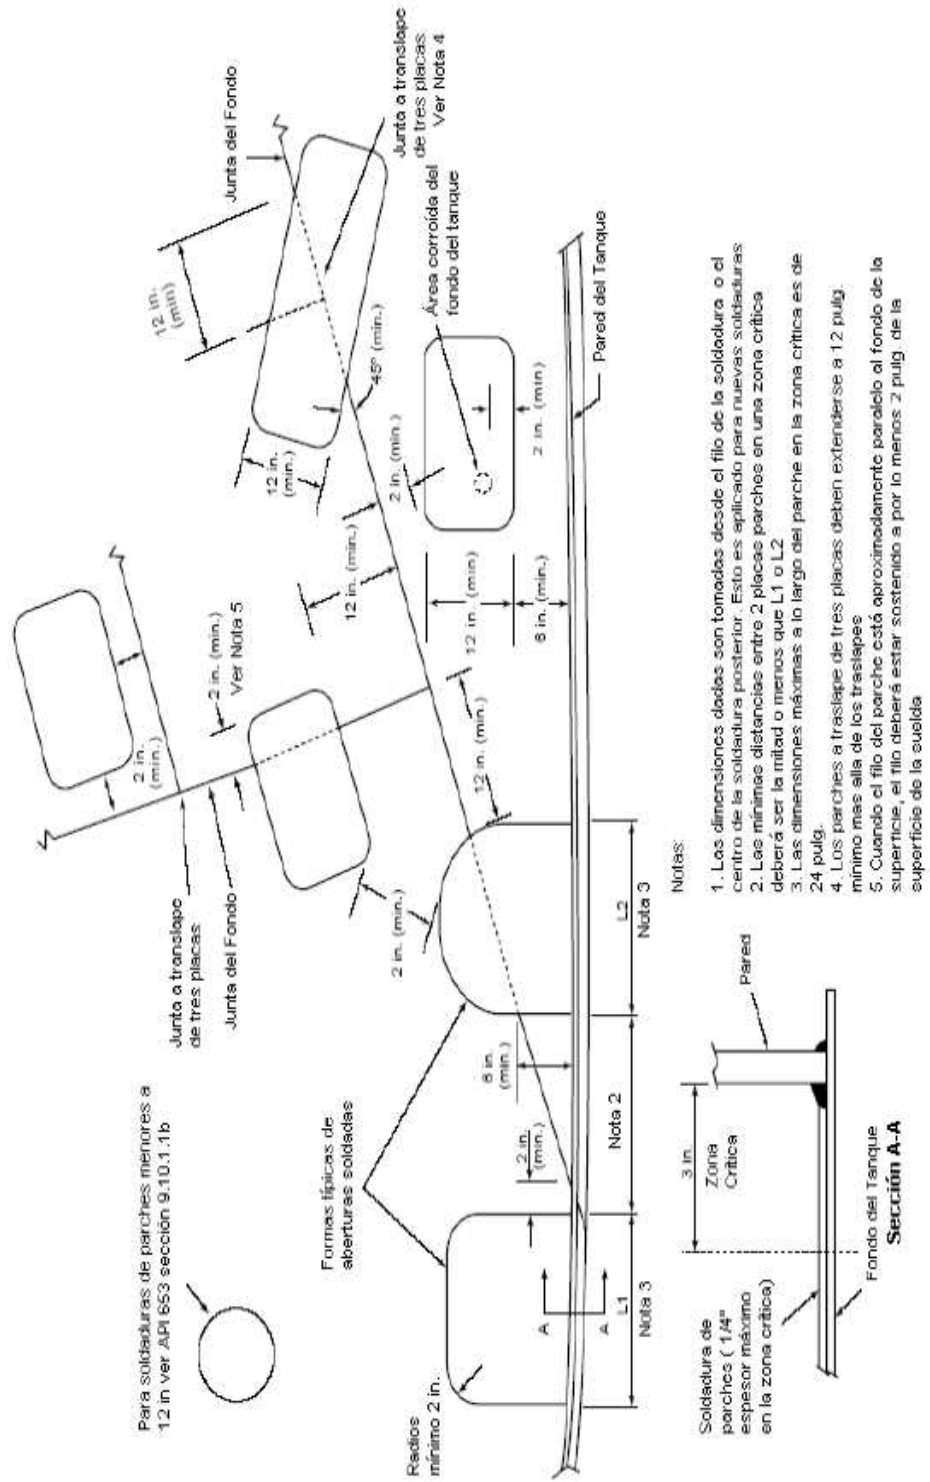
Típicas Placas de Parches Soldadas en las Placas de Fondo
